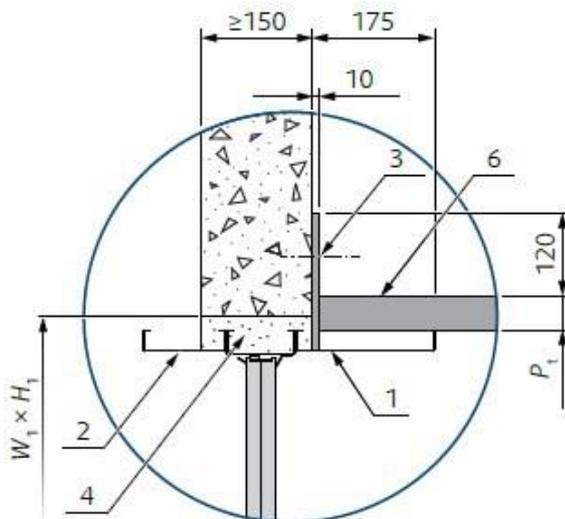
(EI120S) Sezione trasversale di ☉ installazione umida in parete rigida
